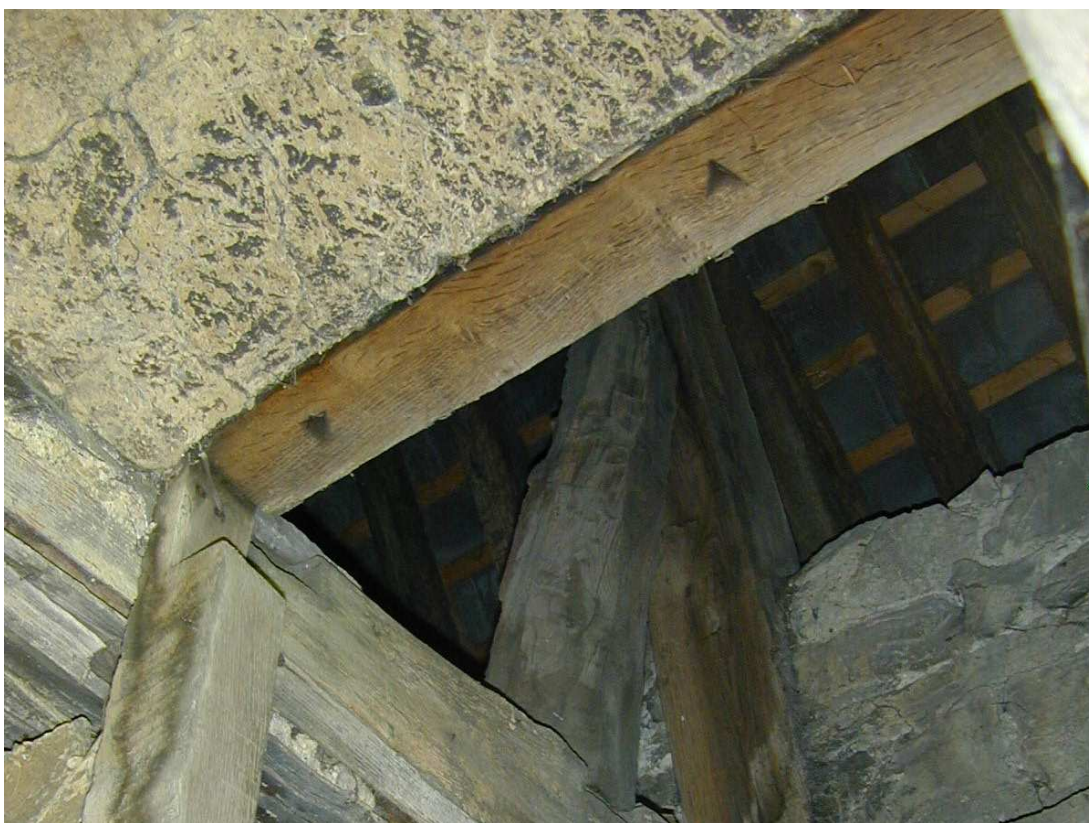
1^{er} étage. Détail torchis du plafond et traverse au droit de la trappe d'accès au comble. IG 2003.
